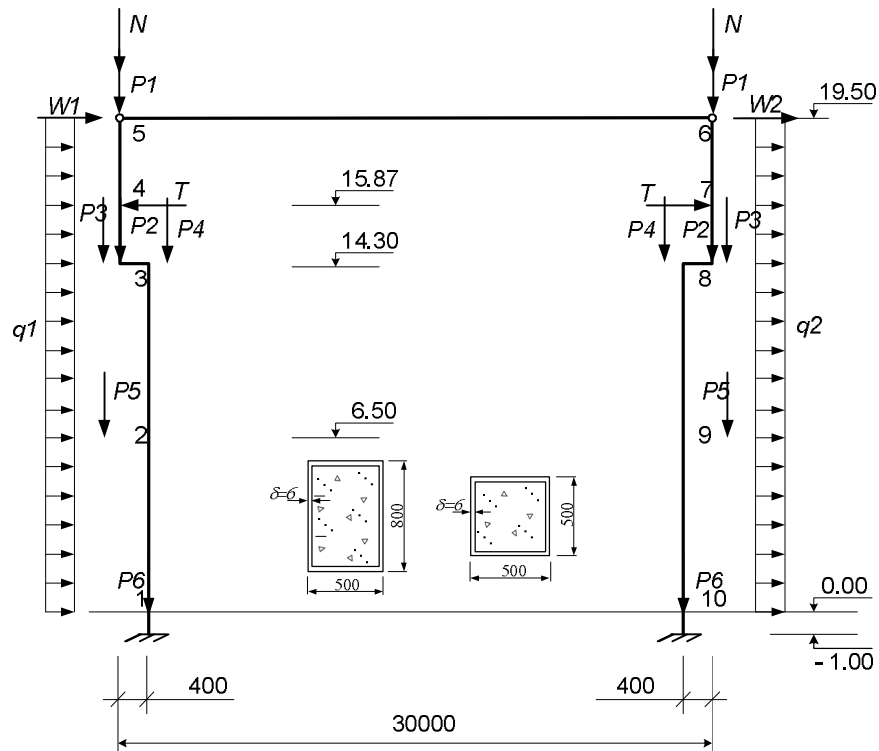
Розрахункова схема рами: P_1, N – опорний тиск на колону від ферми й снігу; P_2 – вага верхньої частини колони; P_6 – вага підкранової частини колони; T – поперечне гальмування; P_4 – кранове навантаження, вага підкранової балки й гальмових площадок; q_1, W_1, q_2, W_2 – вітрові навантаження; P_3, P_5 – вага панелей
